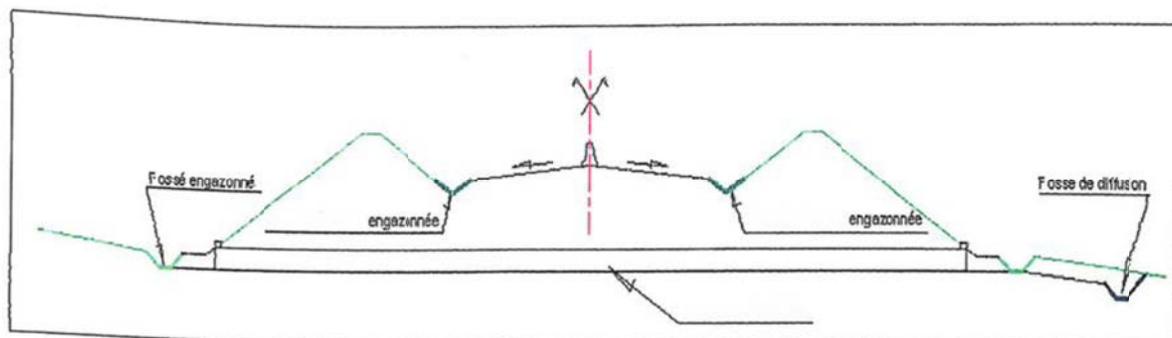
Schéma en coupe d'un ouvrage hydraulique de la future RN 27
